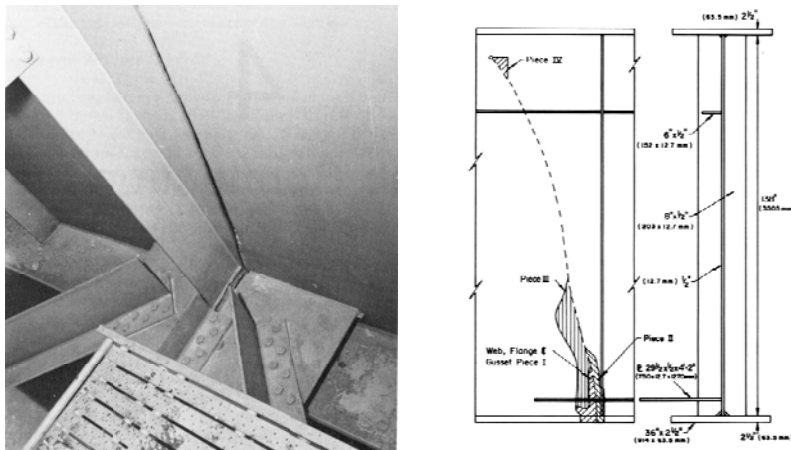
Frattura nella trave principale del Lafayette Street Bridge [8]
